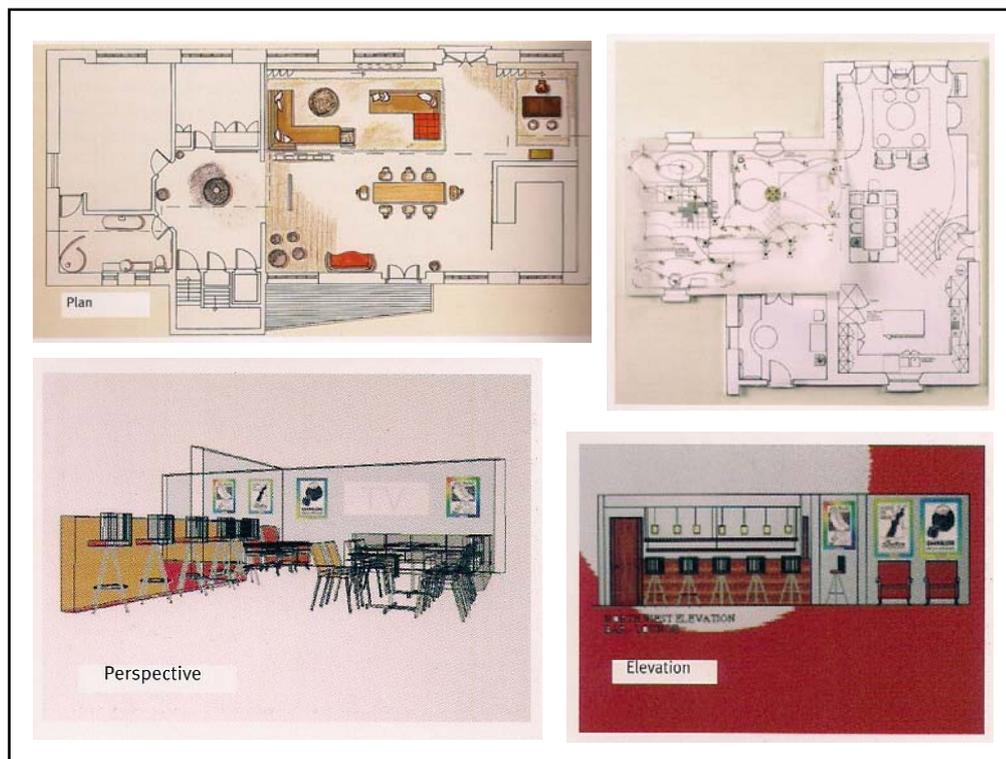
Exemplos de representação: planta-baixa com estudo de cor, mobiliário e instalações; planta-baixa e planta de iluminação; perspectiva e elevação. Fonte: Gibbs, 2005, p. 88, 89.
